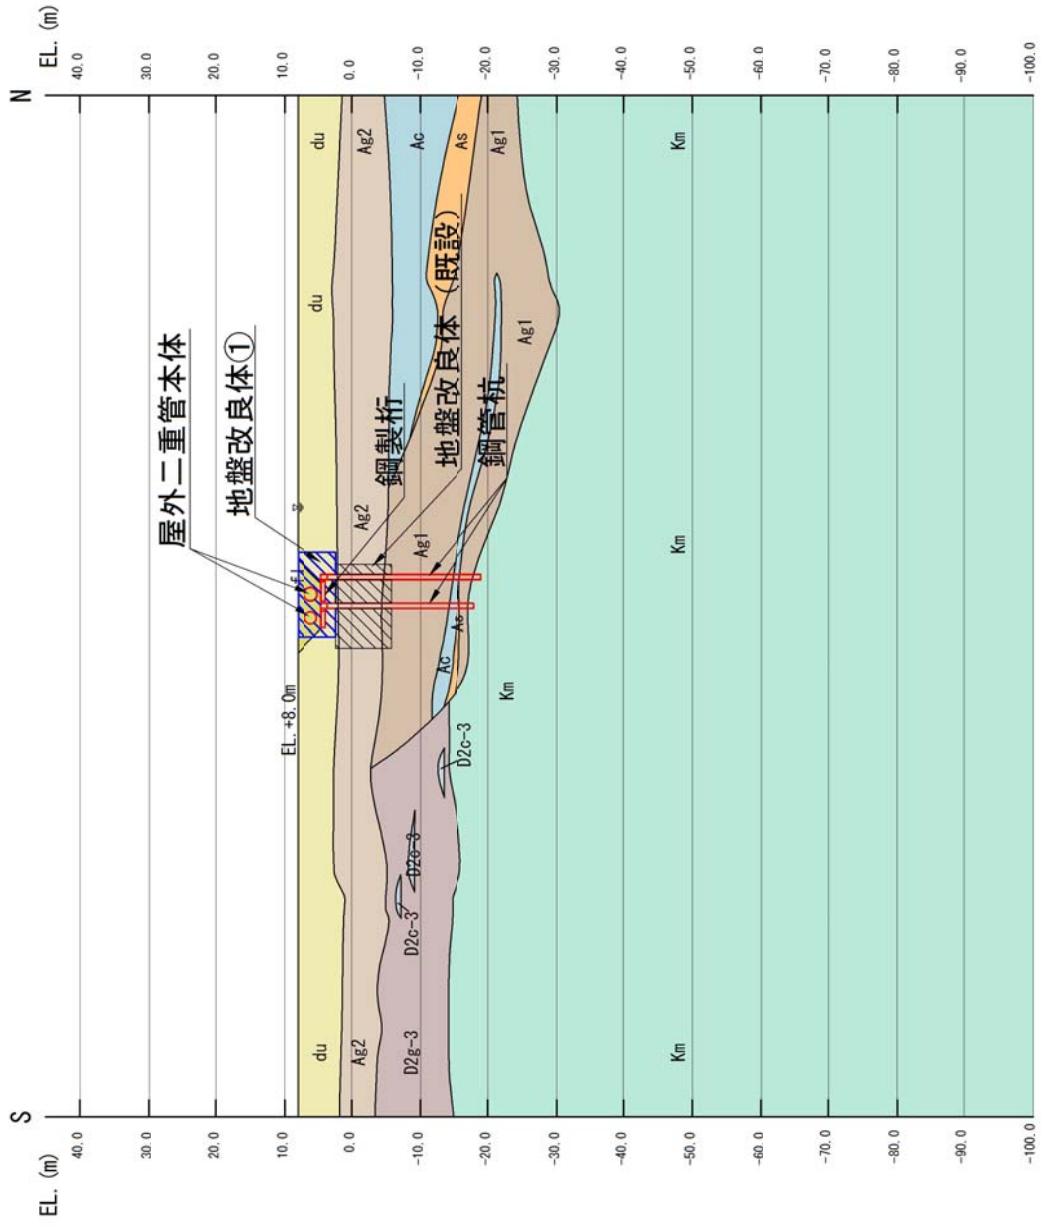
(3) 屋外二重管基礎の評価対象断面図 (C-C 断面・杭基礎構造部)
